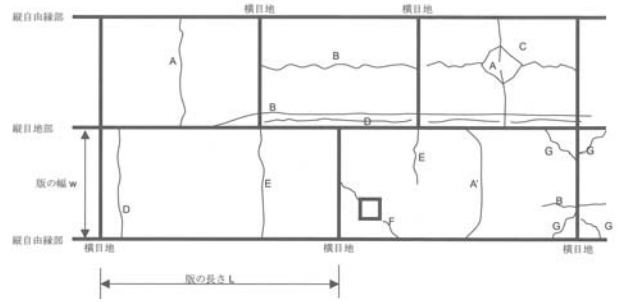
構造的なひび割れ発生の種類（平面図）
